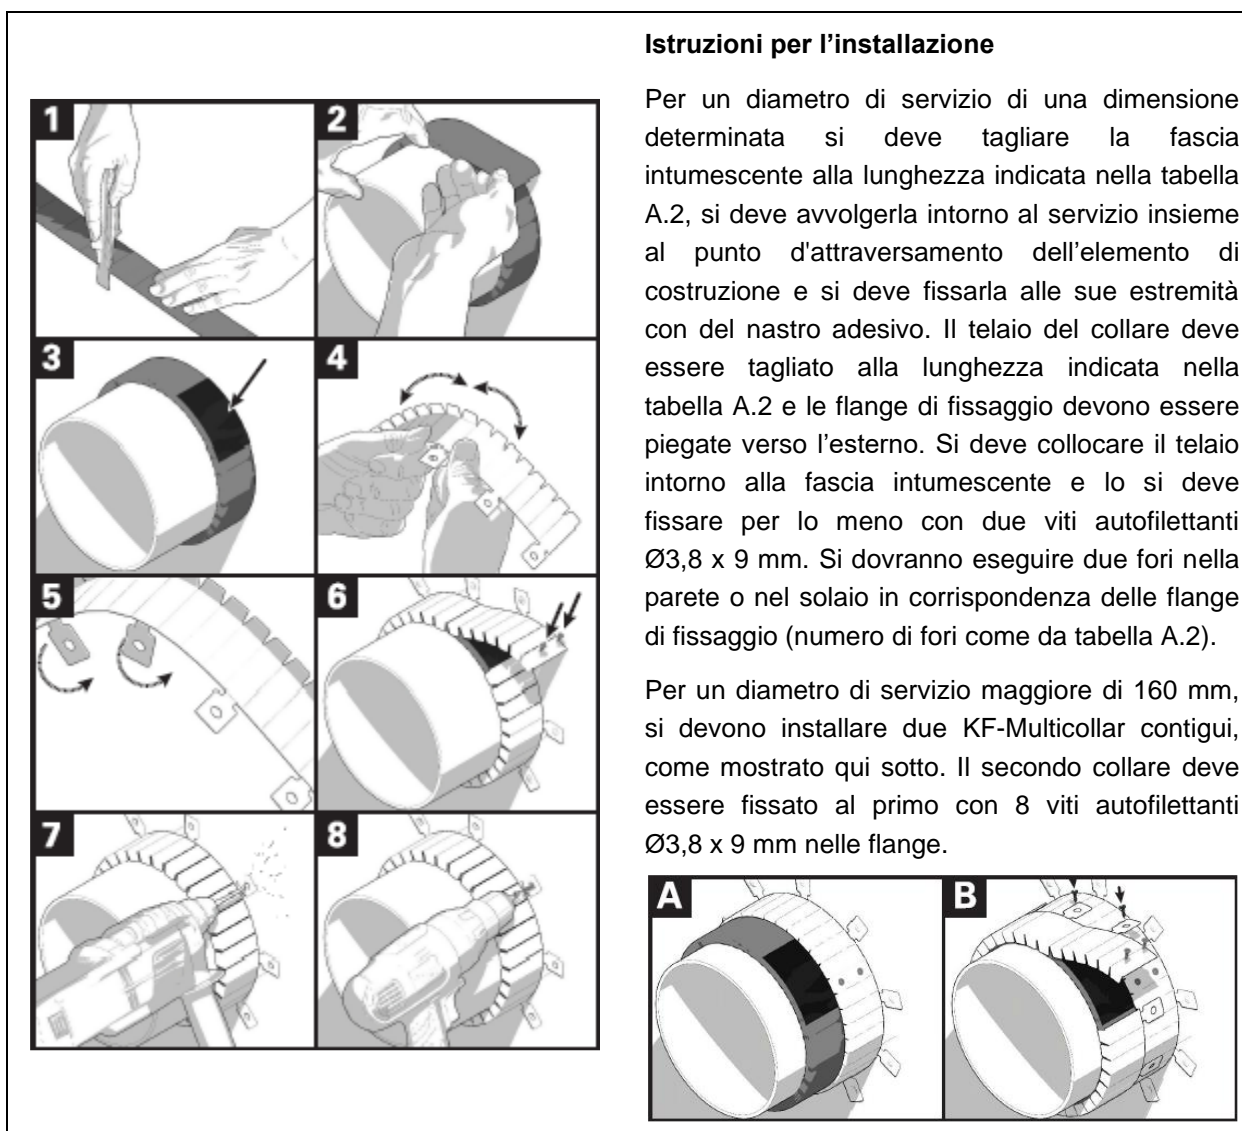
Passaggi dell'installazione di KF-Multicollar.
